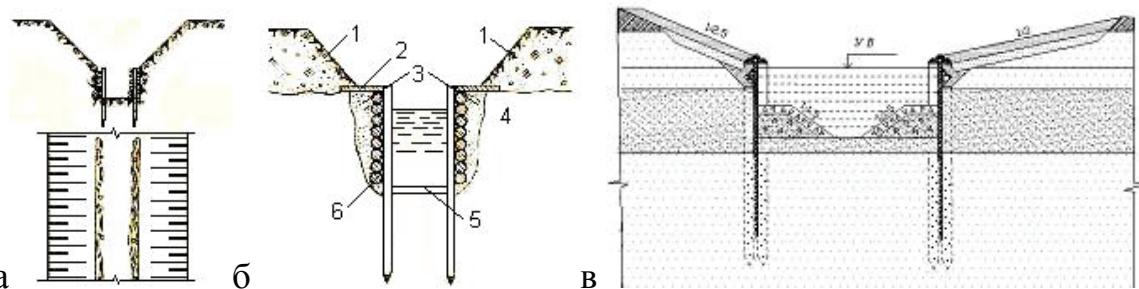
Варианты крепления подводящих каналов и канав: хворостяным забором (а), жердями (б), сваями, обшитыми досками (в); 1 – водонепроницаемый устойчивый грунт; 2 – дёрн; 3 – песок; 4 – оплывающий грунт; 5 – распорка; 6 – жердевая заборка
